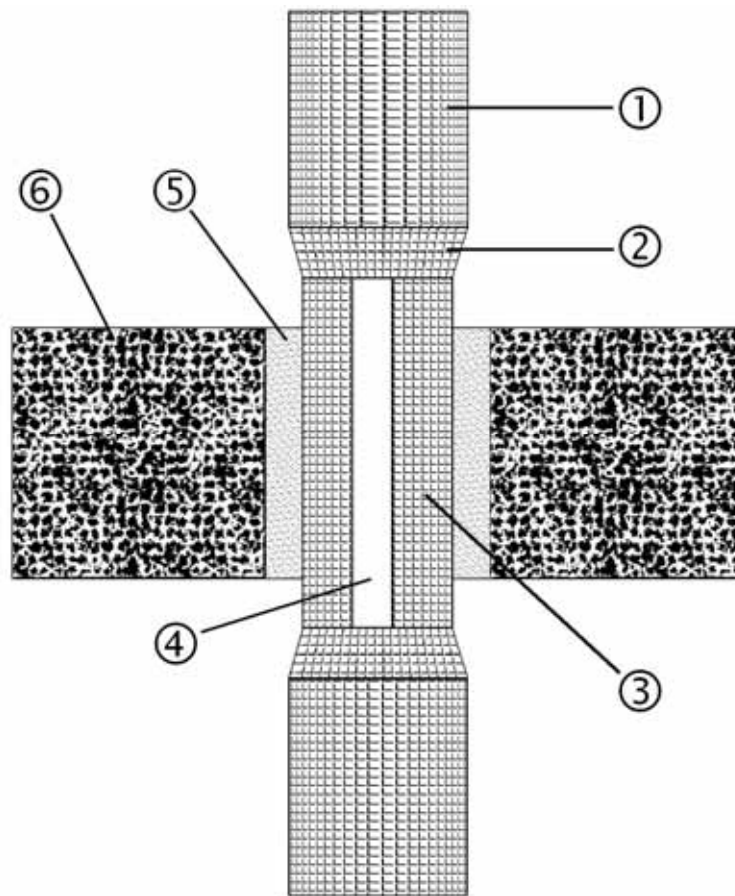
Formstücke (Abzweige, Bögen, Verbinder u. ä.) für gusseiserne Abwassersysteme mit schnell und einfach zu montierenden nicht brennbaren, Körperschalldämmenden Brandschutz-Dämm- Manschetten im Deckenverguss (Werkbild Missel)
